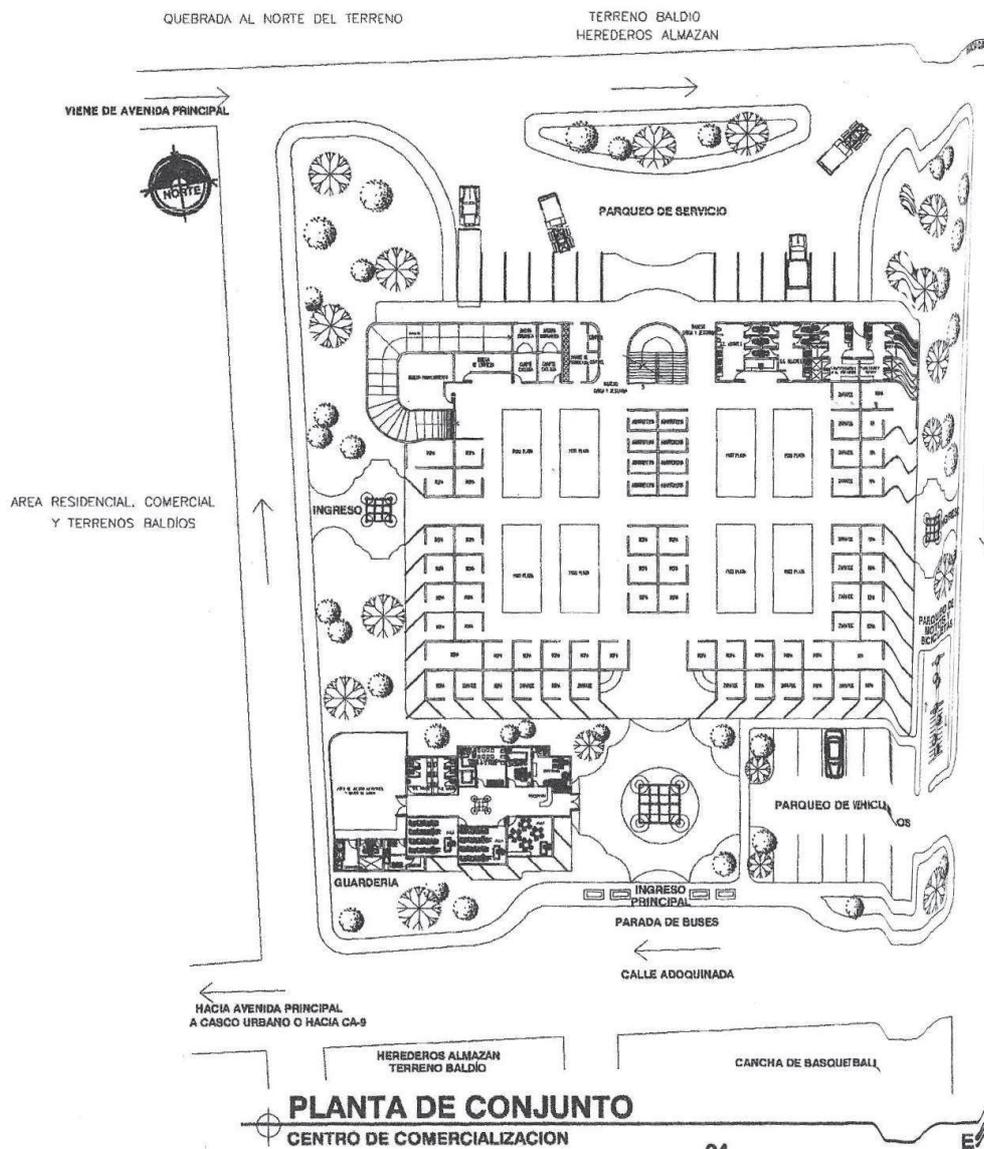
PLANTA DE CONJUNTO PRIMER PISO
